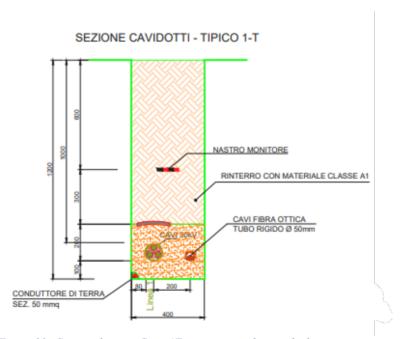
Sezione di scavo Cavo AT + cavo segnale e corda di rame su terreno
